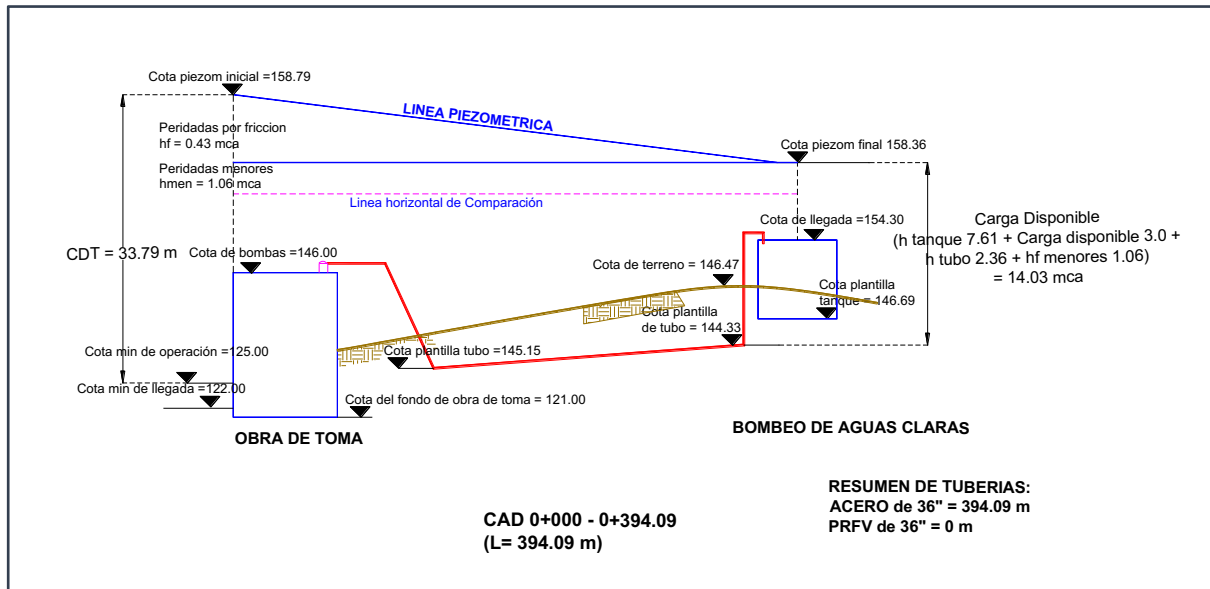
Piezométrica de la obra de toma a la planta potabilizadora, Alternativa 3
